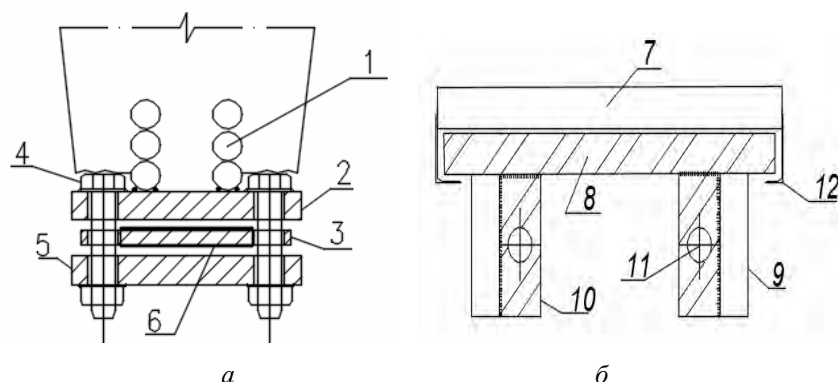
Конструкции неподвижного (а) и натяжного (б) анкеров: 1 — пакет арматуры; 2 — верхняя пластина; 3 — пластина, обернутая ламелью; 4 — высокопрочный болт; 5 — нижняя прижимная пластина; 6 — углепластиковая ламель; 7 — стальная пластина; 8 — стальная пластина натяжного анкера; 9 — ребро жесткости натяжного анкера; 10 — вертикальная пластина; 11 — отверстие под высокопрочный болт; 12 — уголок № 16
